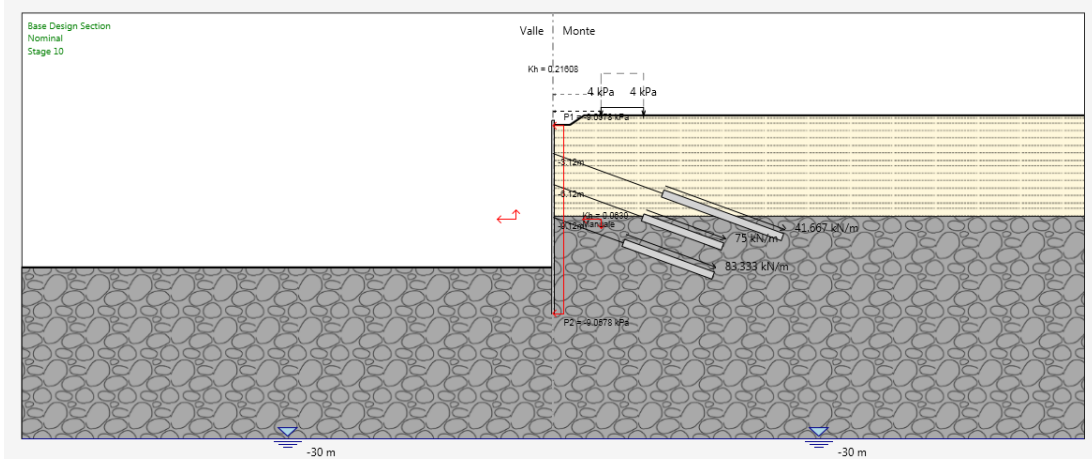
Step 9: Applicazione dell'azione sismica di progetto.
